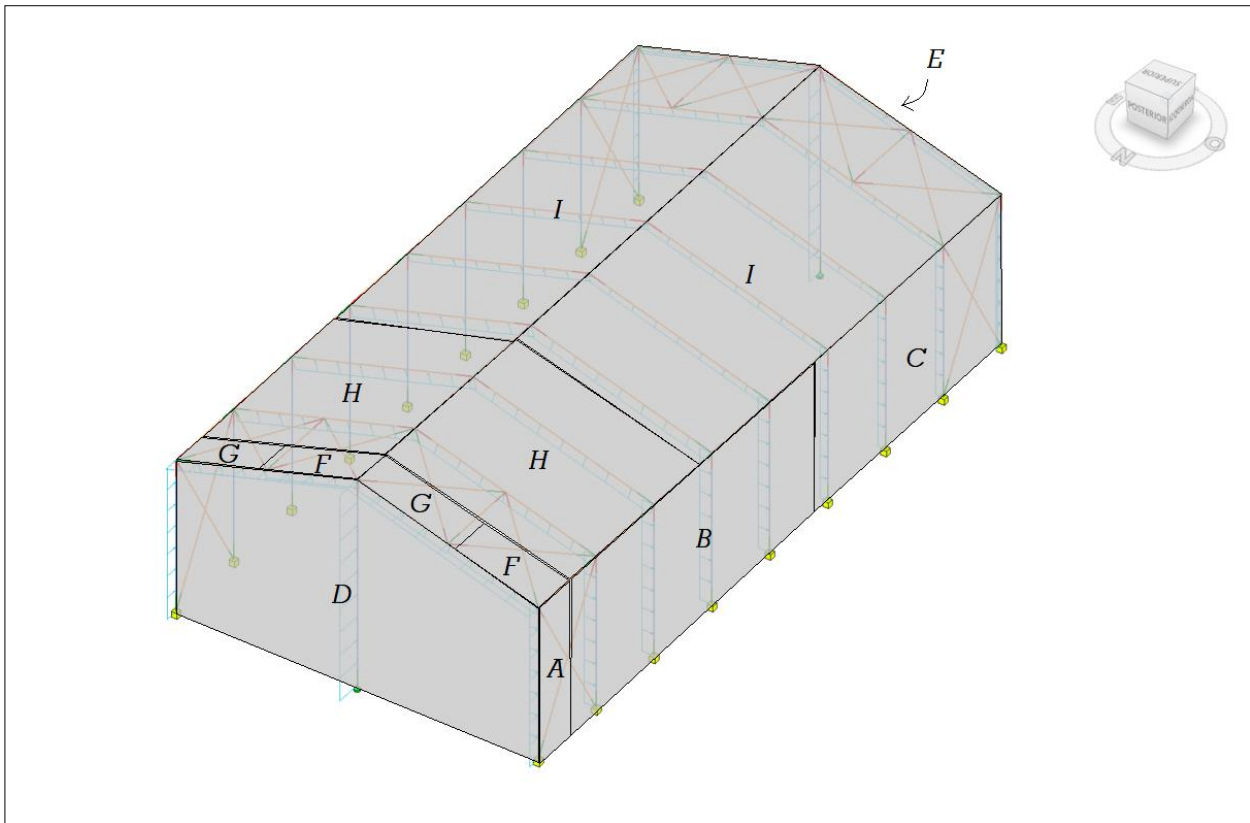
Zonas eólicas para viento norte aplicadas a la nave
